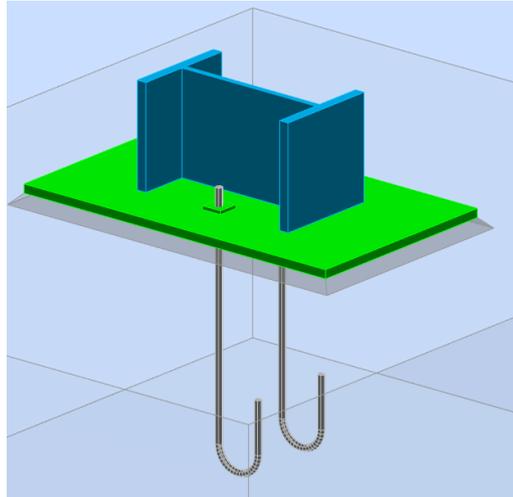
UNIÓN POSTE – PLACA DE ANCLAJE DE PÓRTICO INTERIOR
